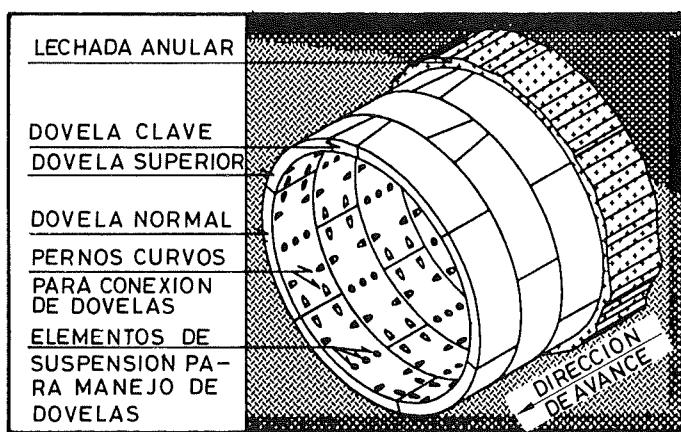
Revestimiento dovelado prefabricado de hormigón con jaulas completamente soldadas y recubiertas de epoxi.
